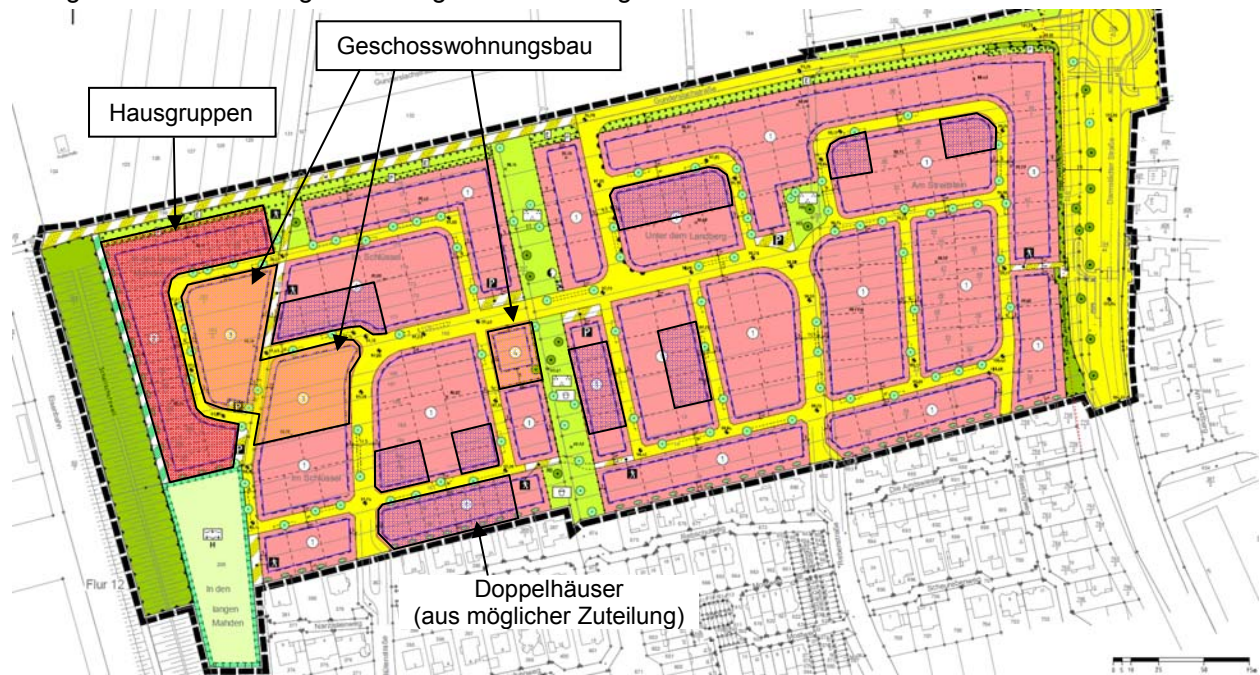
Auszug Bebauungsplan-Entwurf (Planstand 30.03.2016)
